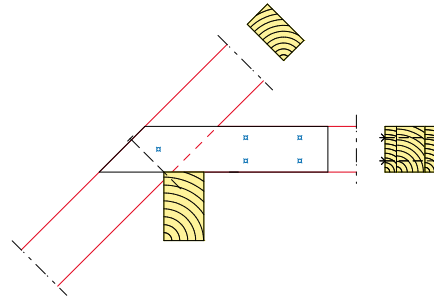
Kehlbalkenanschluss mit Pfette unterhalb
